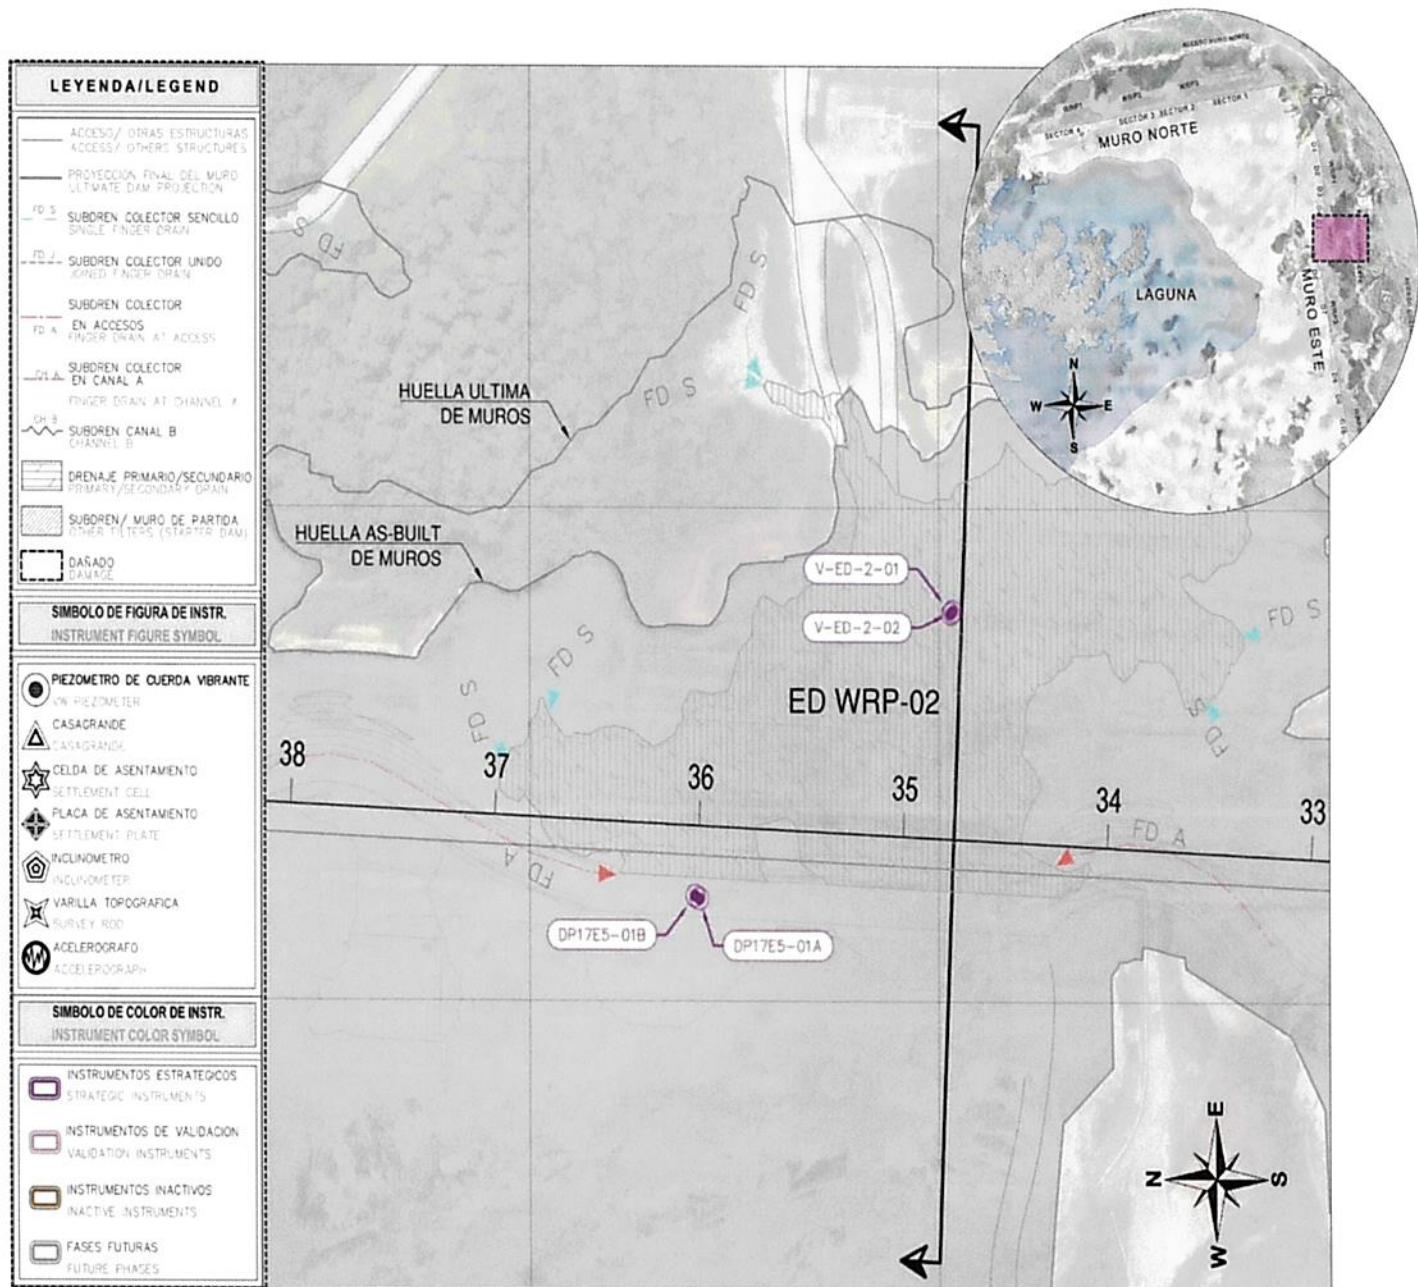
Vista de Planta en el Muro Este WRP2 con Piezómetros
